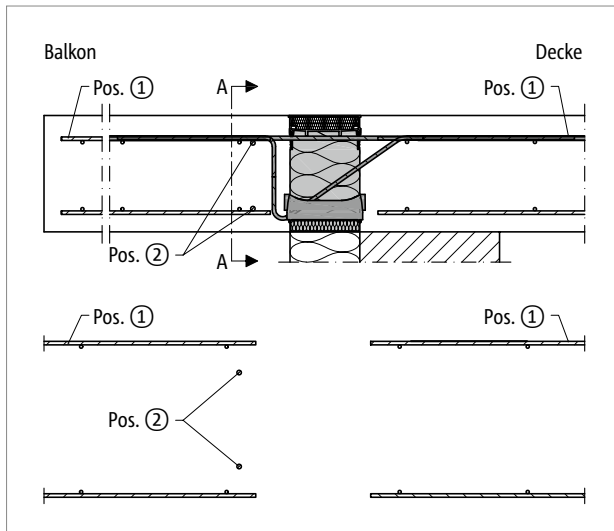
Schöck Isokorb® XT Typ K-M1 bis M10: Bauseitige Bewehrung bei direkter Lagerung
